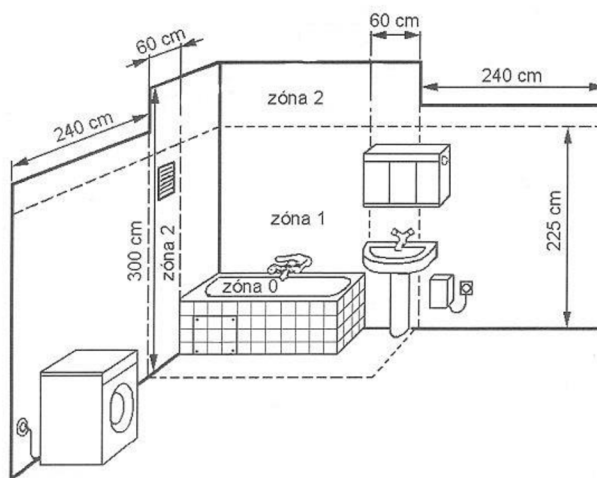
Umístění instalačních zón (Upraveno podle [6])
